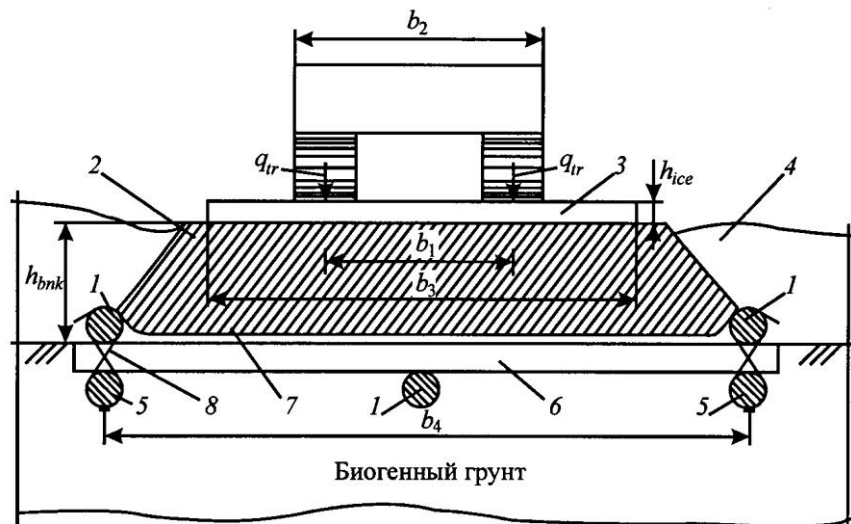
Расчетная схема зимней дороги на биогенном грунте: 1 – продольные лаги-ограничители; 2 – насыпь из минерального грунта; 3 – снежно-ледяное покрытие; 4 – уплотненный снег; 5 – нижние продольные лаги; 6 – прореженный поперечный настил; 7 – геотекстильная прослойка; 8 – проволочная скрутка
